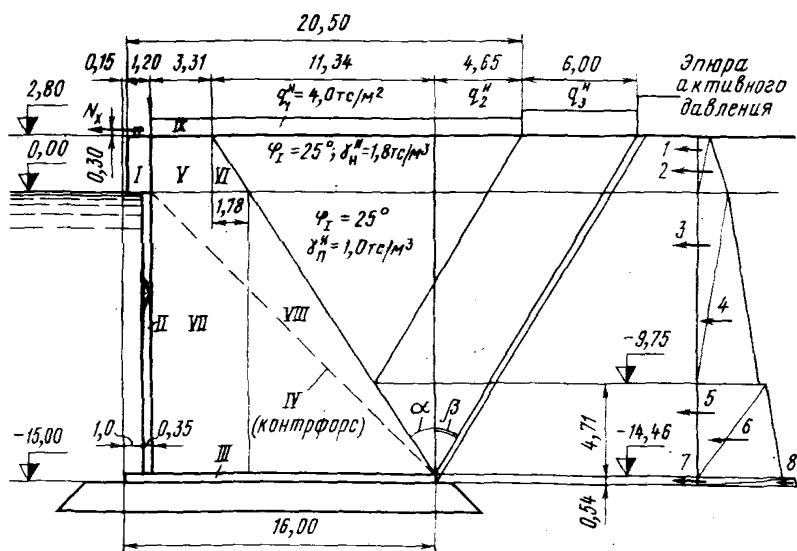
Расчетная схема конструкции и эпюра активного давления грунта
